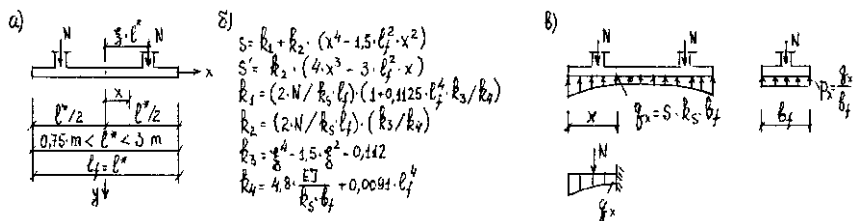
К расчёту короткой балки: а – схема нагружения, б – основные зависимости, в – эпюра отпора грунта и расчётная схема
